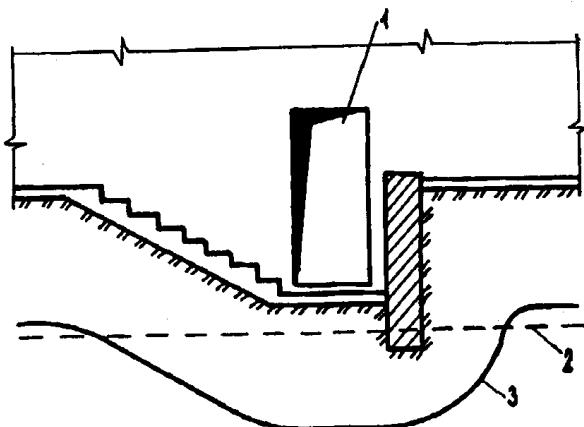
Схема промерзания грунтов у входа в подвал:
